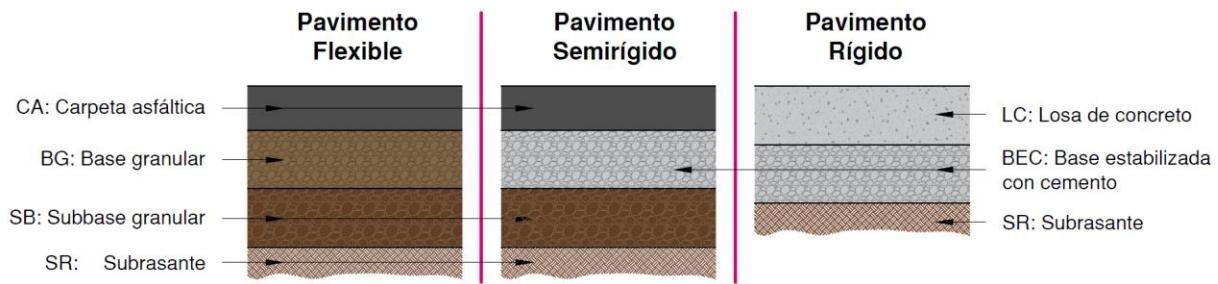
Estructura de pavimento flexible (izquierda), pavimento semirígido (centro) y pavimento rígido (derecha)
